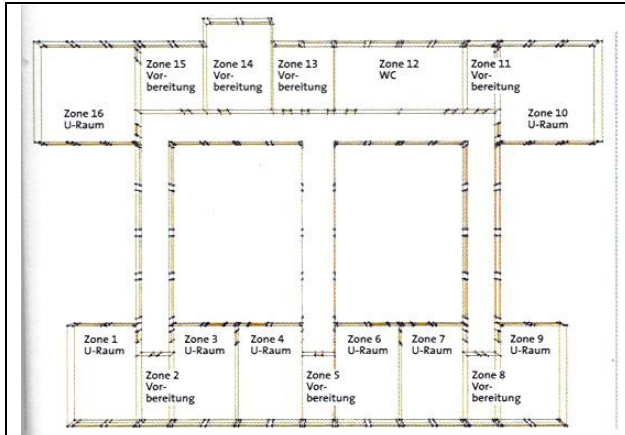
Grundriss für Schultyp „Dresden“ [17]
